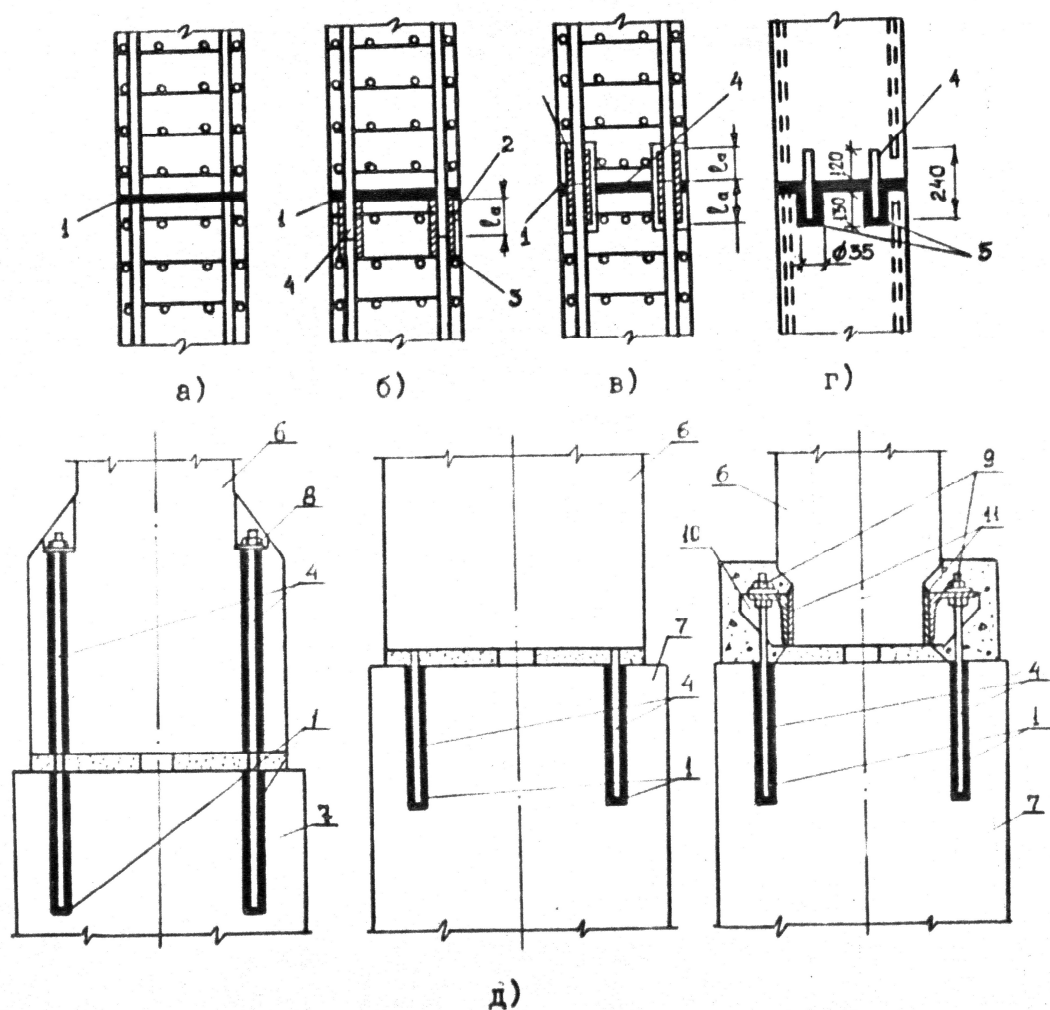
Клеевые стыки сборных железобетонных колонн (а, б, в), свай (г) и сборных железобетонных колонн с бесстаканными фундаментами (д): 1 – клеевой шов; 2 – муфта; 3 – сварной шов; 4 – арматурные выпуски; 5 – отверстие для заложения анкера; 6 – колонна; 7 – фундамент; 8 – инвентарная гайка; 9 – крепежная гайка; 10 – деталь для выверки и крепления колонны; 11 – закладная деталь
